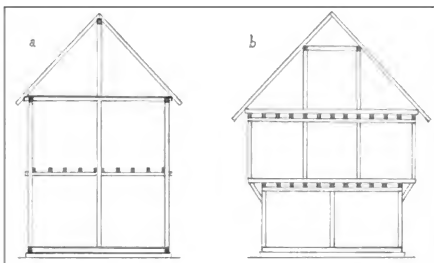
a) Ständergeschosskonstruktion mit eingezapften Unterzügen, b) Stockwerksrähmkonstruktion ab etwa 1600, jedes Geschoss ist einzeln abgebunden und aufgestockt.
